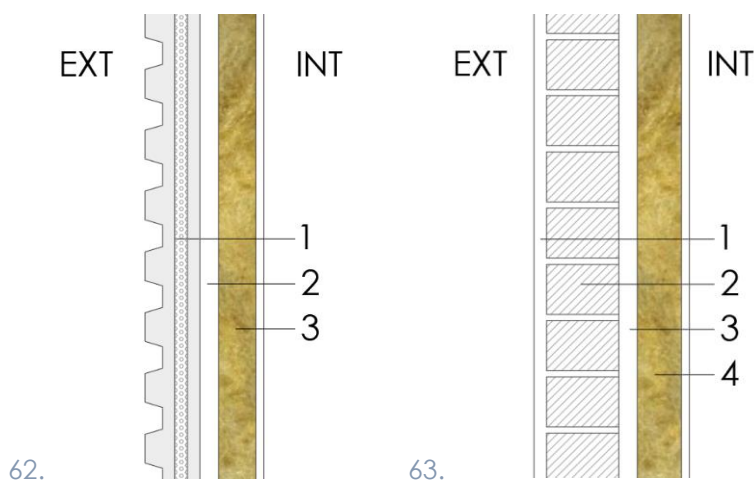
y 63. Detalles de envolvente Tipo 1 y Tipo 2 (secciones verticales) con lana mineral en Burgos. Fuente: Elaboración propia
